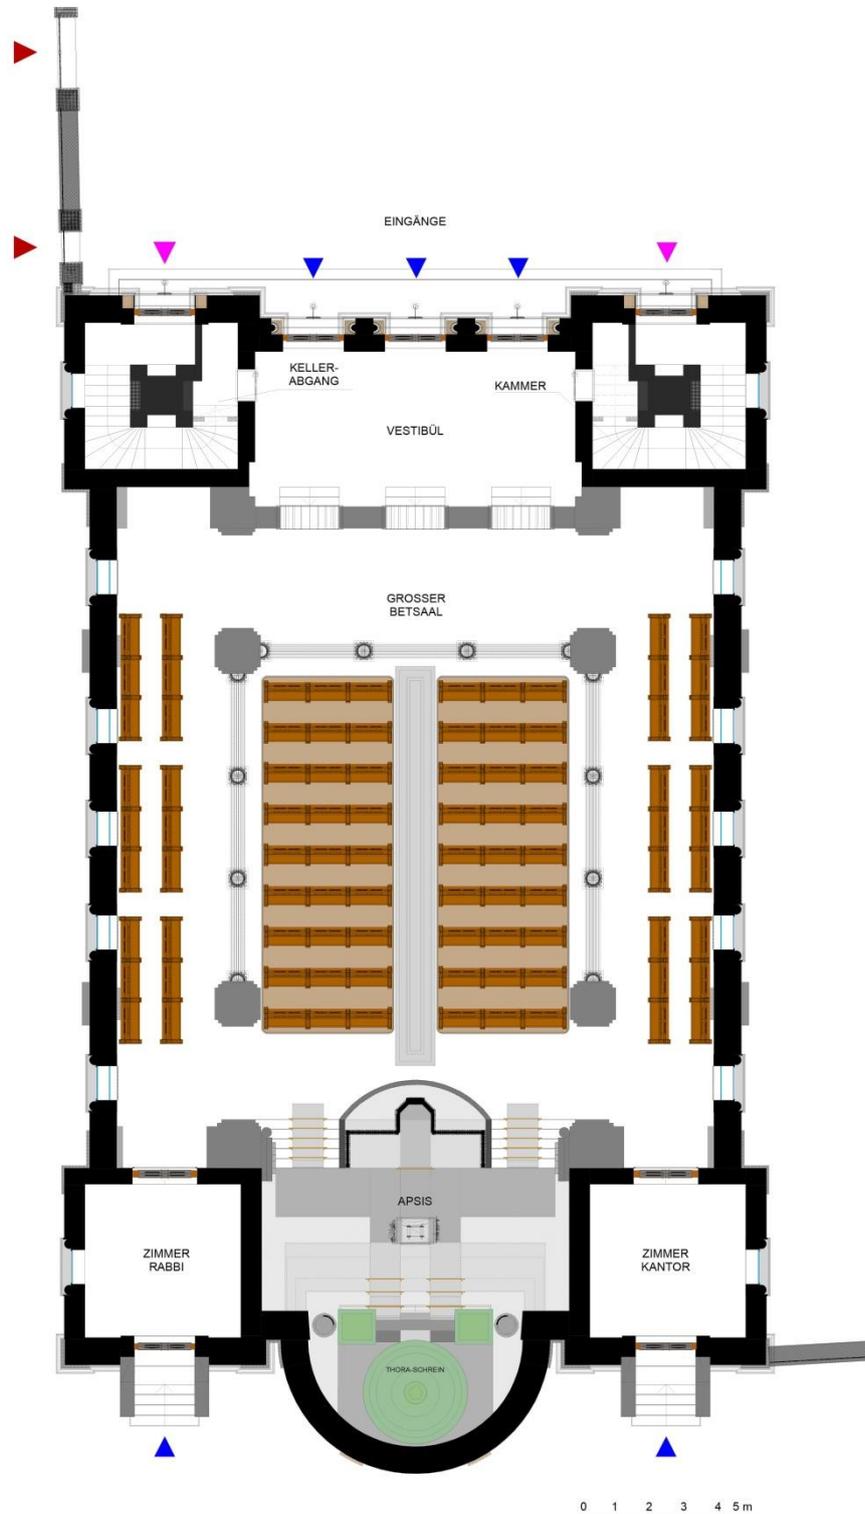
Grundriss Erdgeschoß (ARCHICAD)
